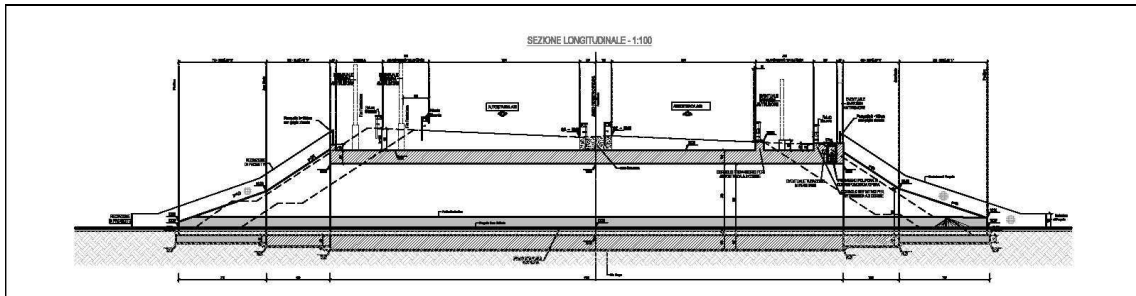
PIANTE E SEZIONE LONGITUDINALE SOTTOVIA VST16
